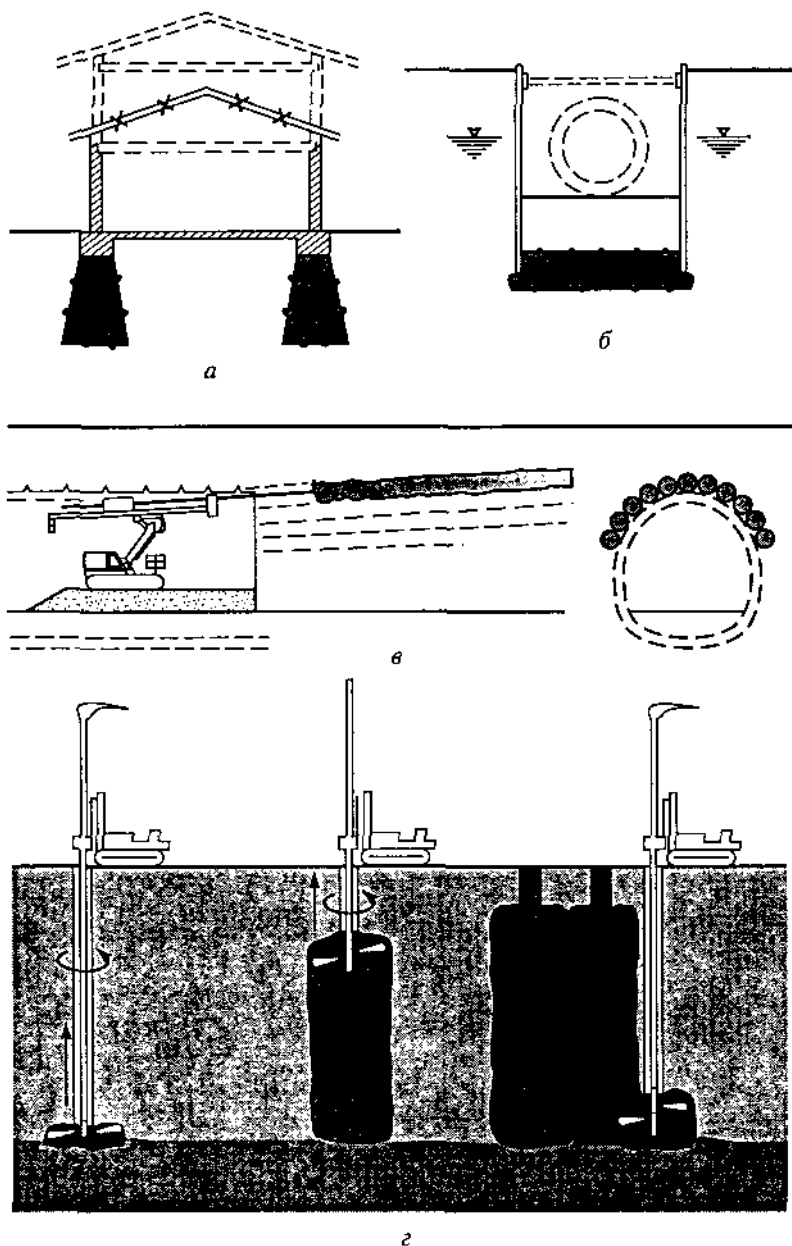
Варианты использования грунтовых свай в качестве: *а* — укрепления оснований фундаментов; *б* — защиты коммуникаций от грунтовых вод; *в* — защиты от обрушения грунта; *г* — шпунтового ограждения
